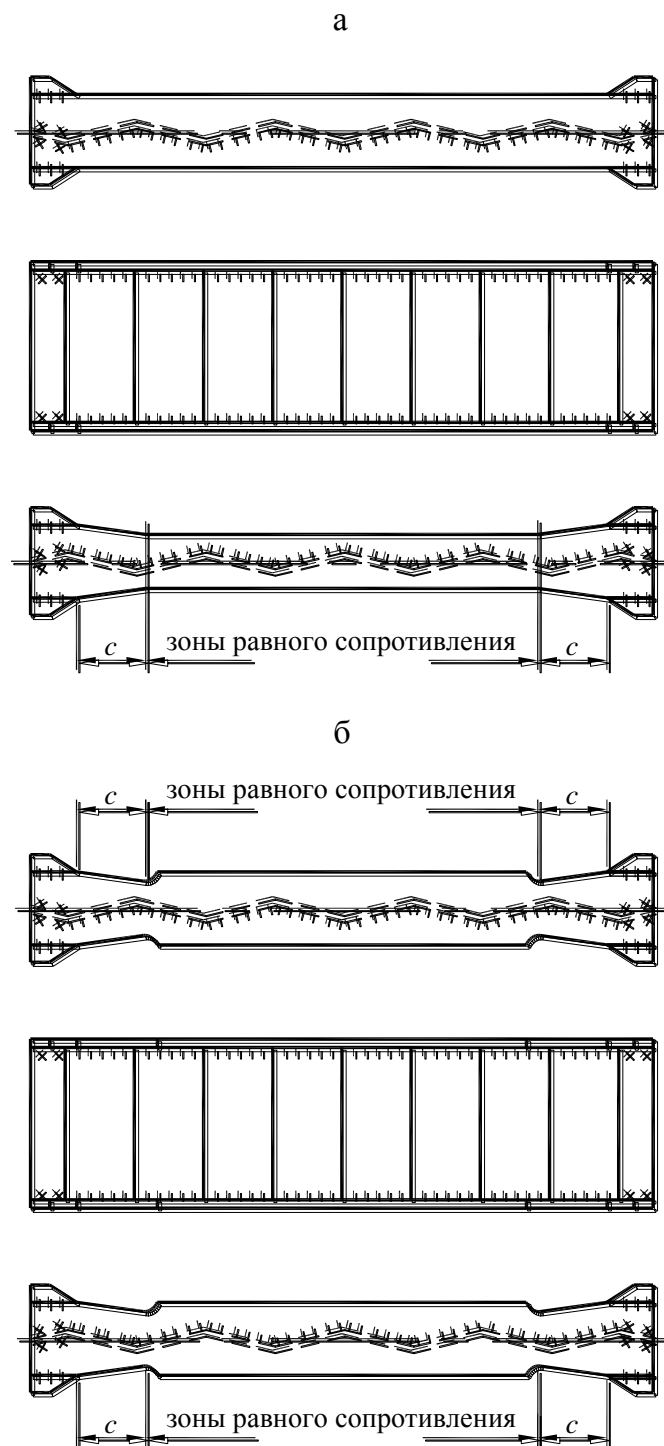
Фрагмент рамного каркаса стального сейсмостойкого здания с двутавровыми колоннами и ригелями с поперечно гофрированными стенками
